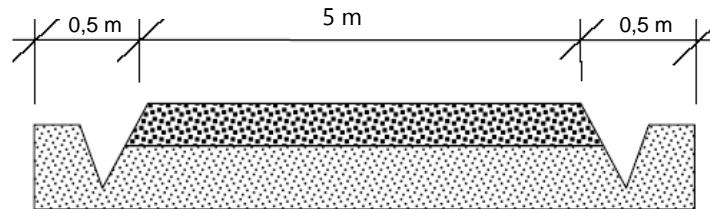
Vue en coupe d'une piste d'accès - Source : Vestas
